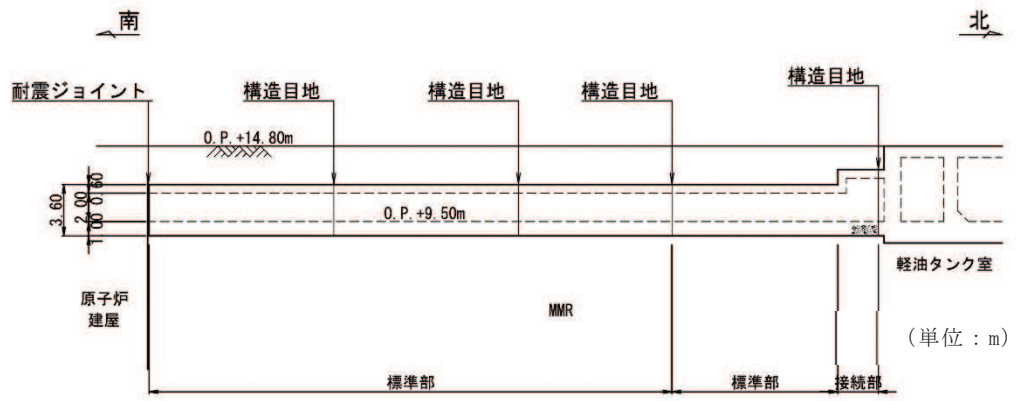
軽油タンク連絡ダクト縦断面図 (C-C 断面)
